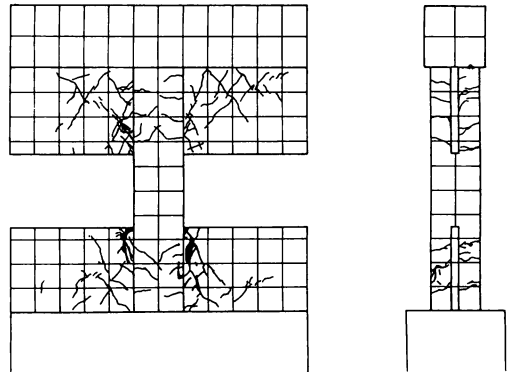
(a) 試験体 CSS01 の最大耐力時のひび割れ図
